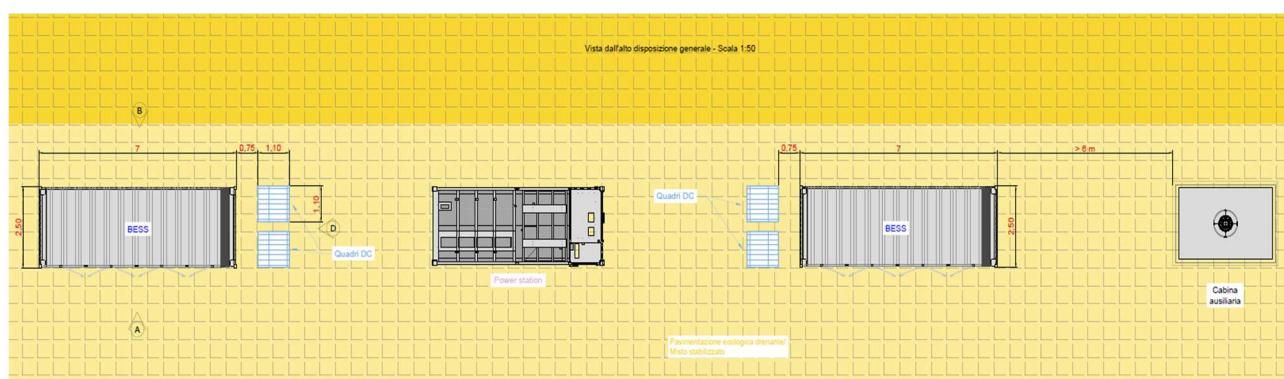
Vista dall'alto disposizione generale piazzale power station – batterie
